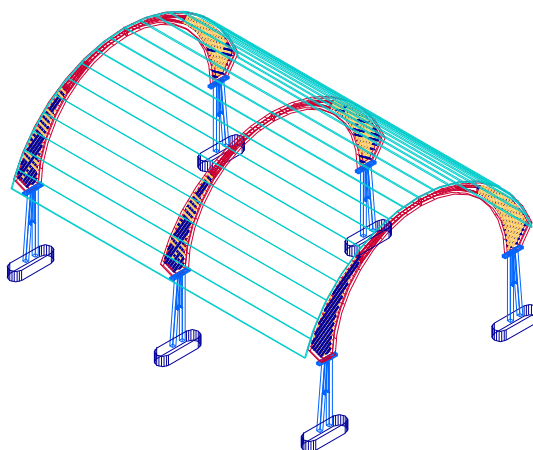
Pórticos / Coberturas do Calçadão de Bauru.
